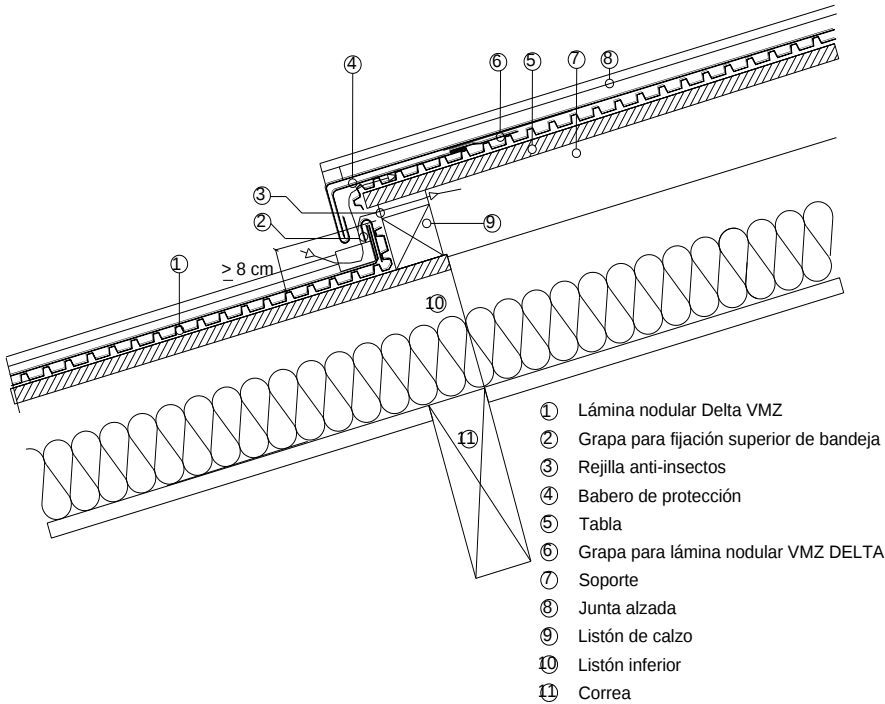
Ejemplo de resalto ventilado para cubierta ventilada con pendiente >5%
